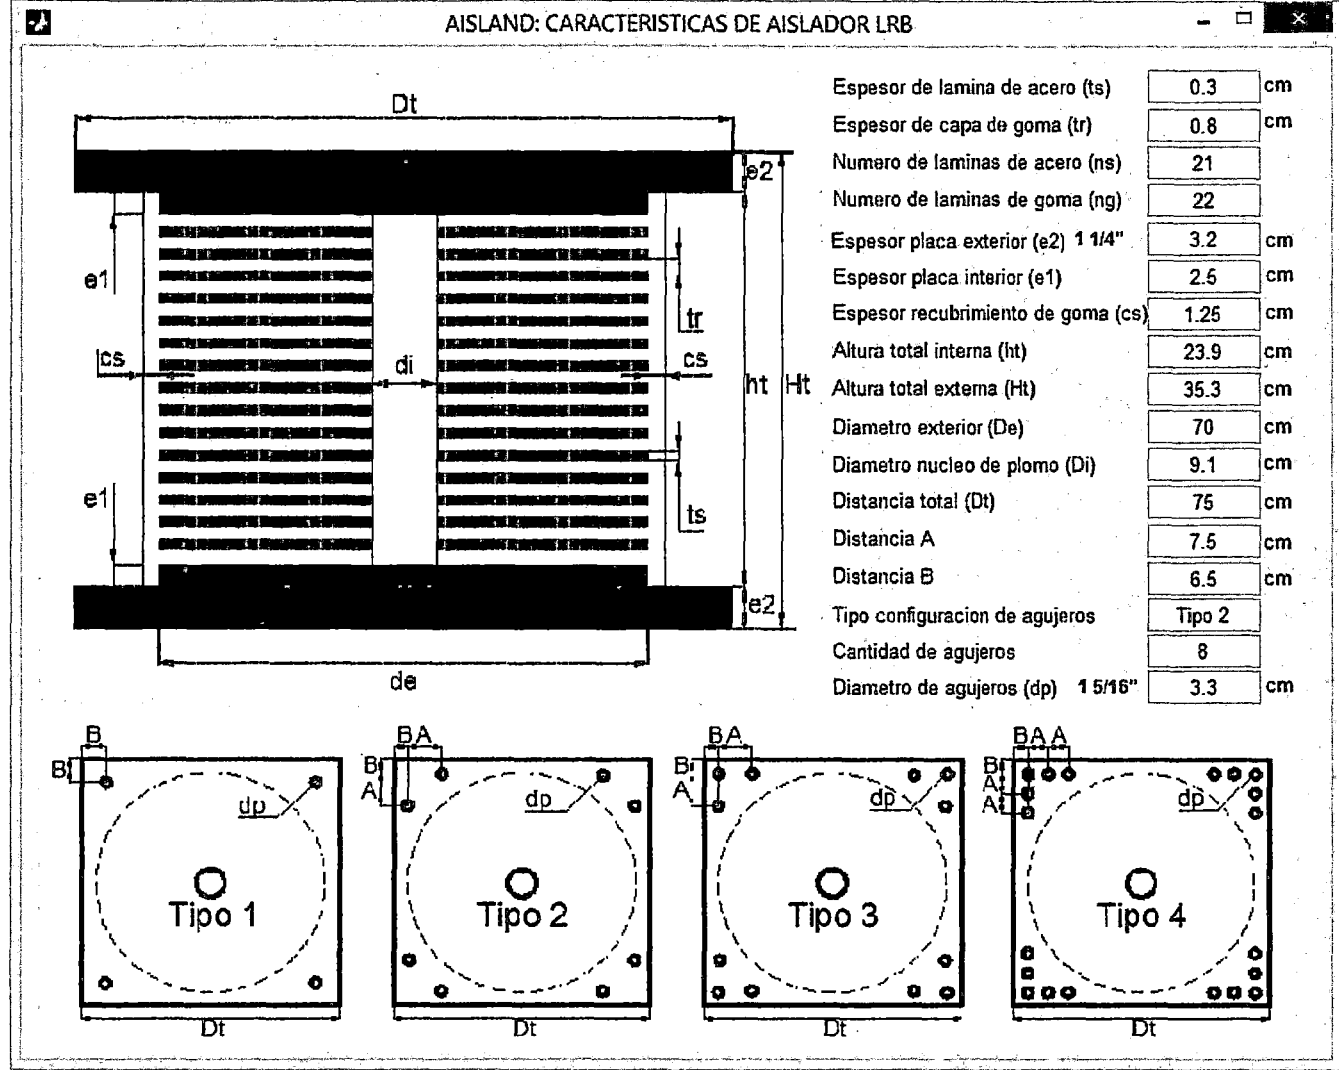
Caso HDR+LRB: Dimensiones geométricas del aislador diseñado LRB.
